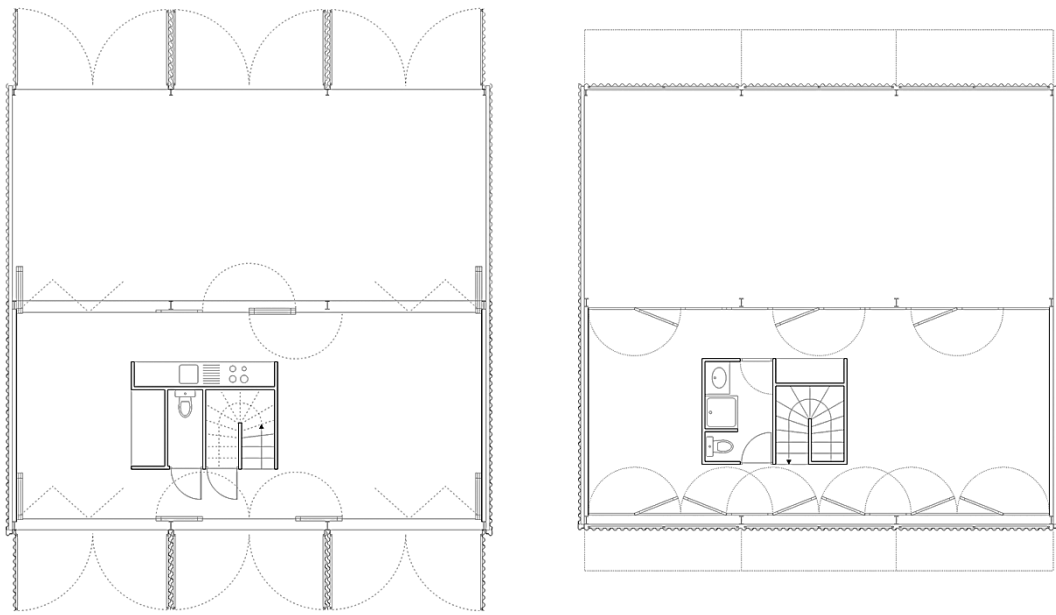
Izquierda, planta baja de la casa Latapie. Derecha, planta primera de la casa Latapie, 1991-1993
